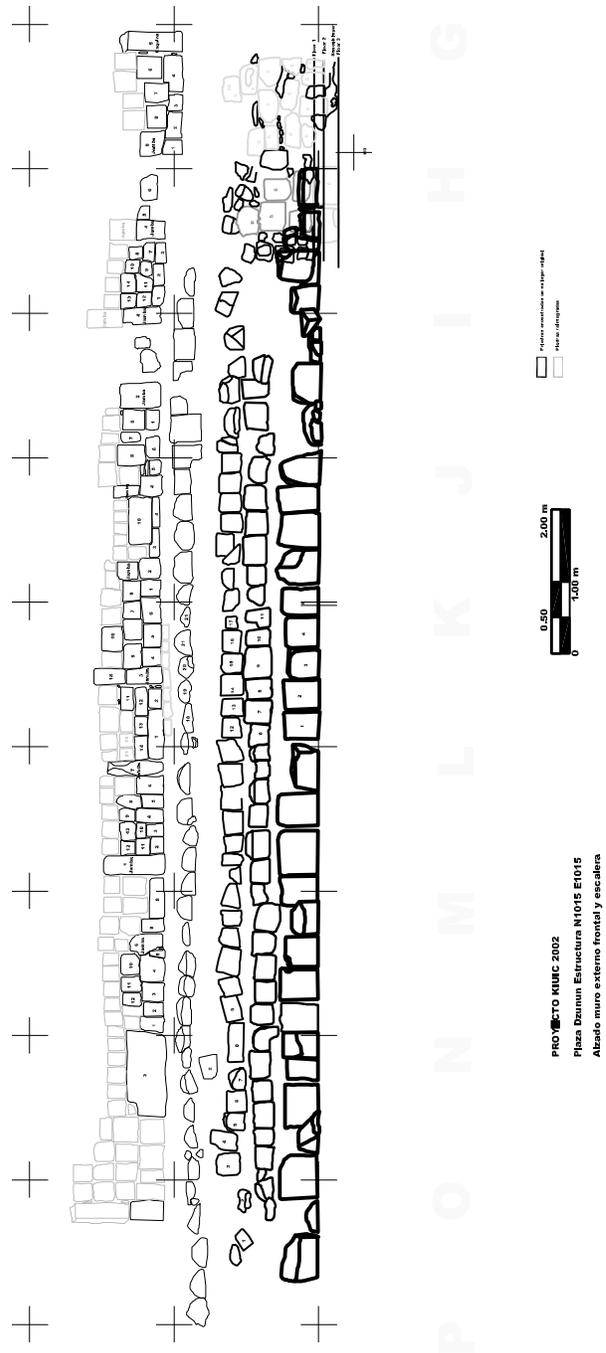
Alzados del muro externo frontal (norte) incluyendo la escalera de acceso actualmente visible de la Estructura N1015E1015.
